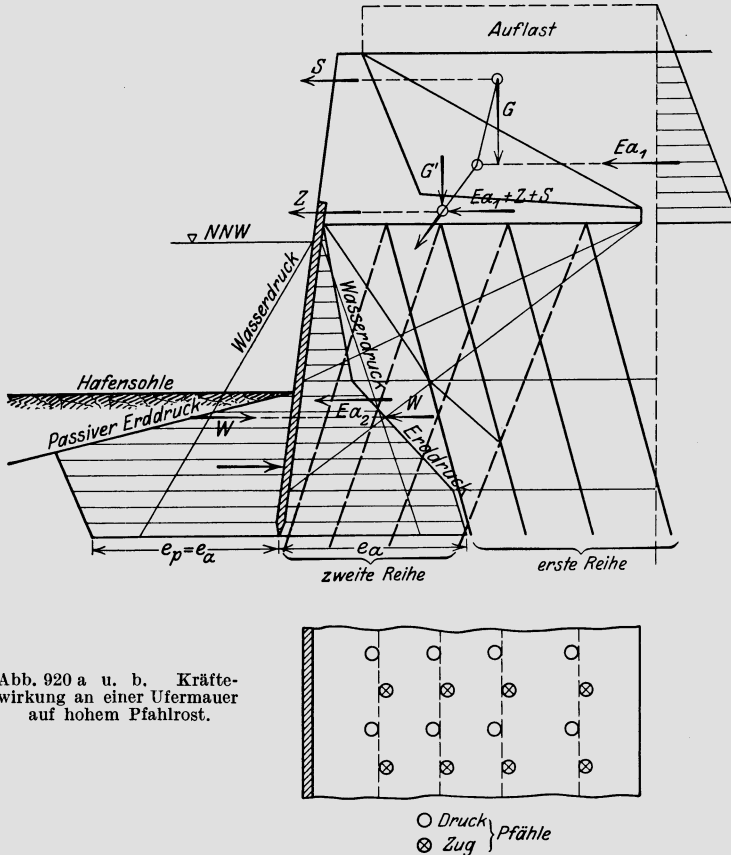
a u. b. Kräftewirkung an einer Ufermauer auf hohem Pfahlrost.
